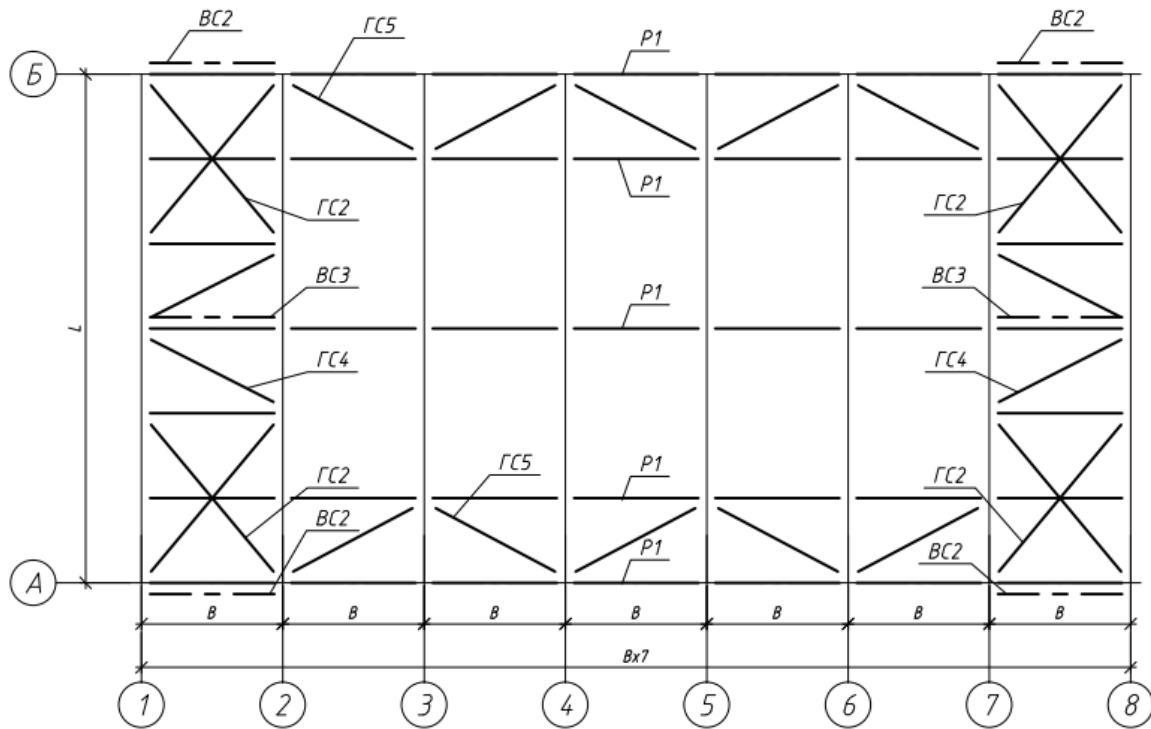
Горизонтальные связи по нижним поясам ферм
